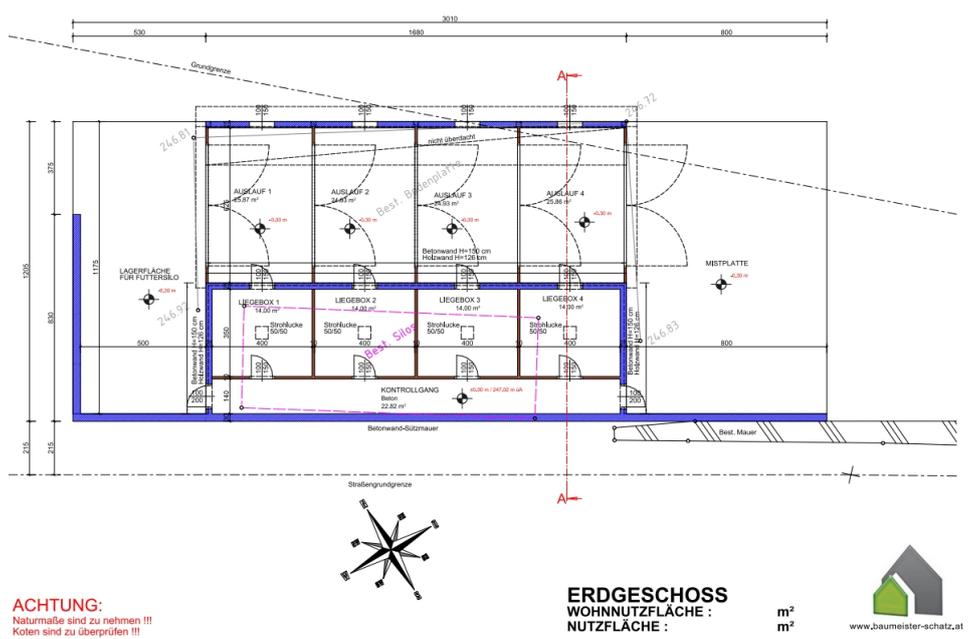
Grundriss Stallgebäude EG, Planungsbüro Schatz KG
